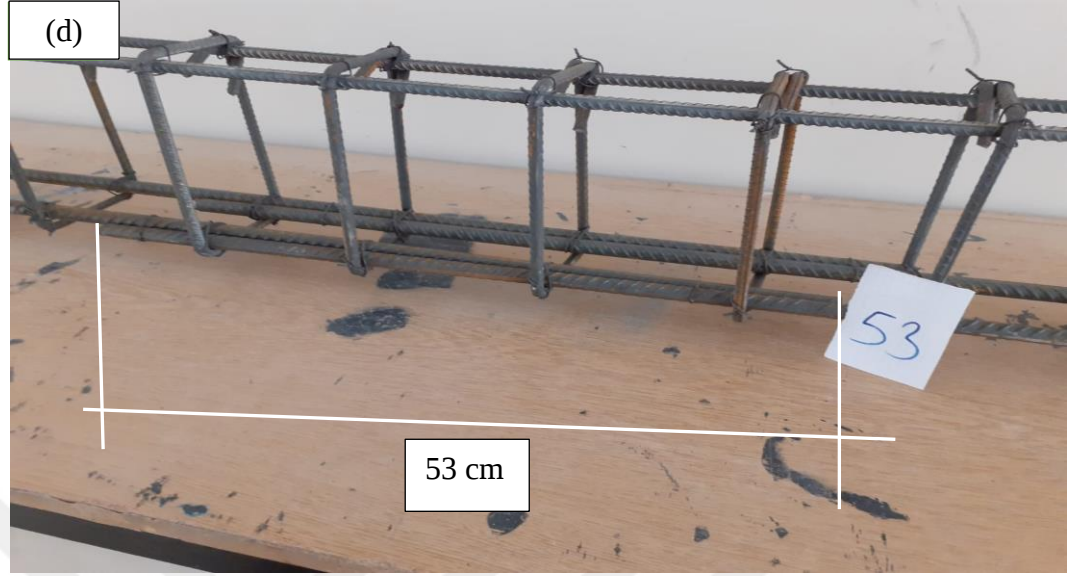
Hazırlanan betonarme kiriş numuneleri
